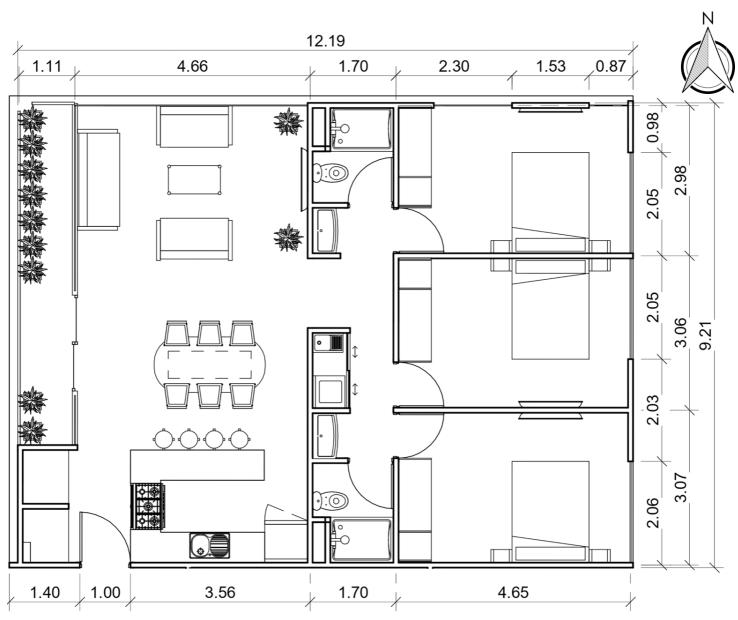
Propuesta final. Planta vivienda Norte. Elaboración propia. 2022
